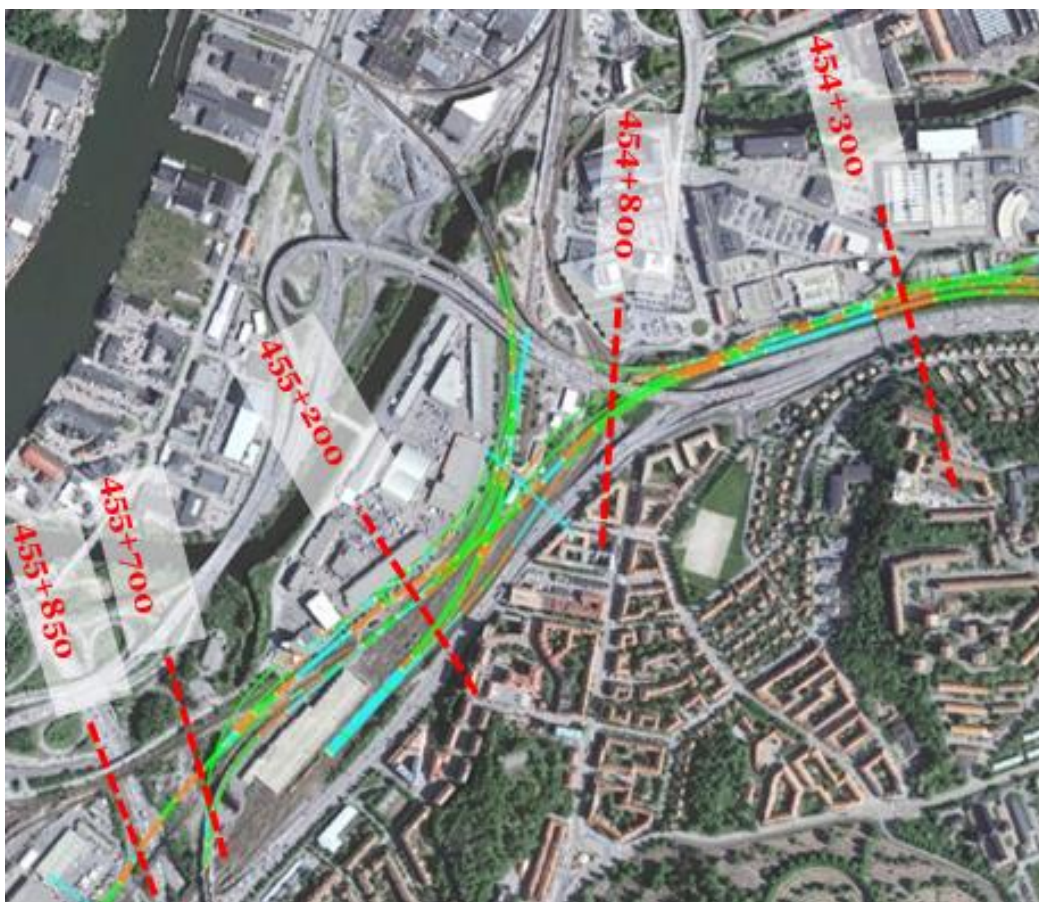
Översiktlig jord- och bergprofil längs Västlänken och Olskrokens planskildhet inom planområdet.
